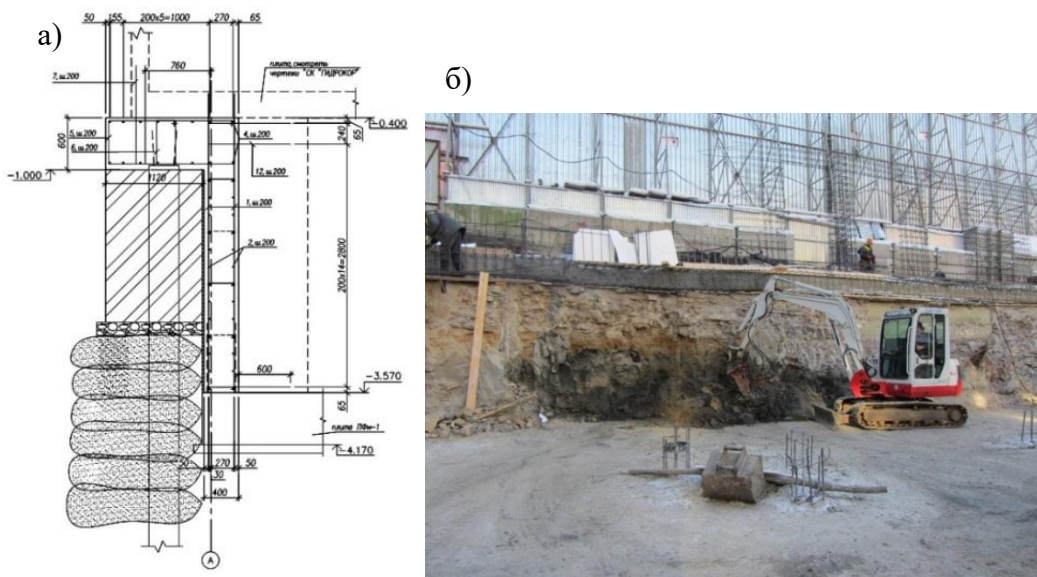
Схема усиления фундаментов по технологии сваи Jet-grouting (а) и работы по разборке участков грунтоцемента для устройства прижимной стенки(б)
